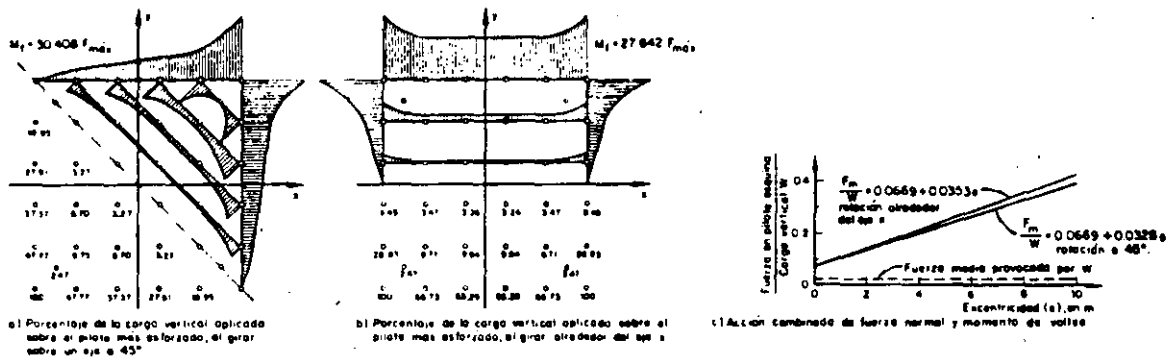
Distribución de cargas en 40 pilotes, provocadas por la acción de momentos flexionantes sobre la cimentación
